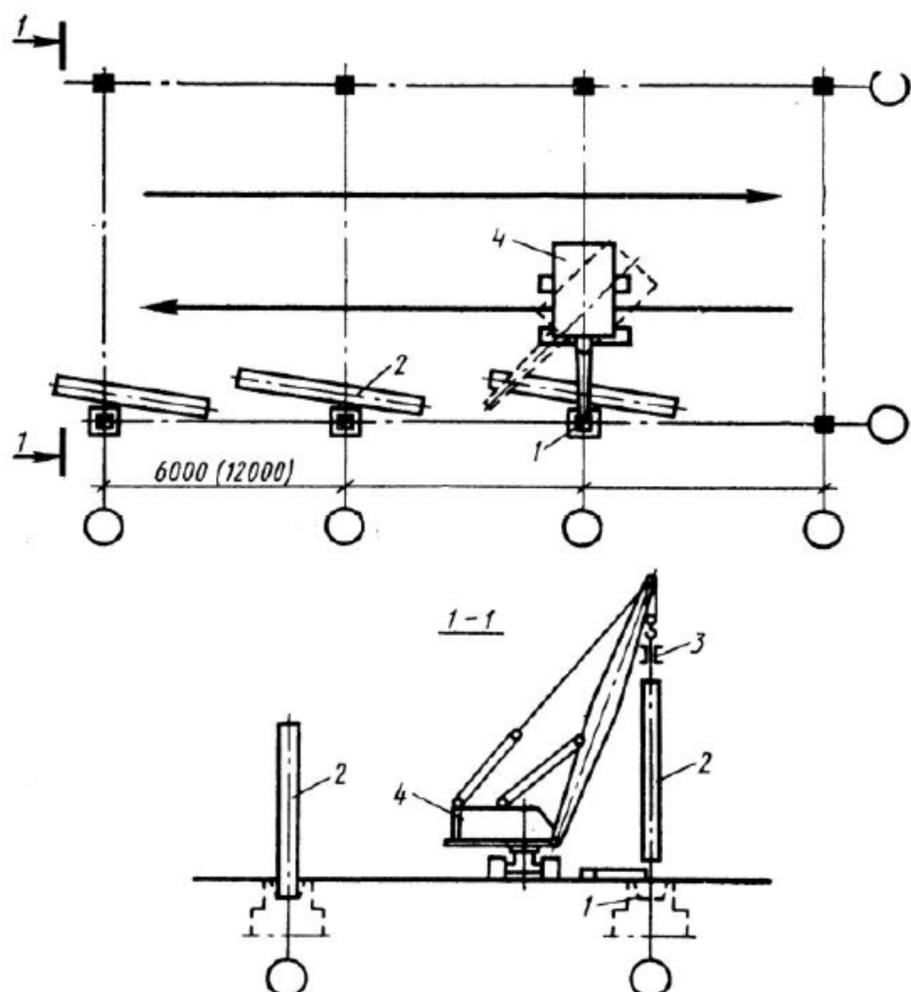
Схема установки колонн в зданиях пролетом 18, 24 и 30 м: 1 - стакан фундамента; 2 - колона; 3 - траверса; 4 - кран.
